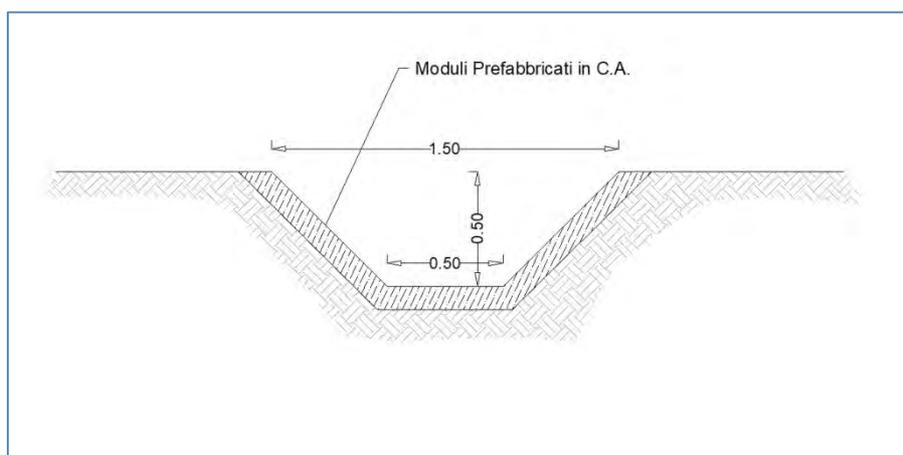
Particolare Cunettone con Rivestimento Prefabbricato in c.a.
